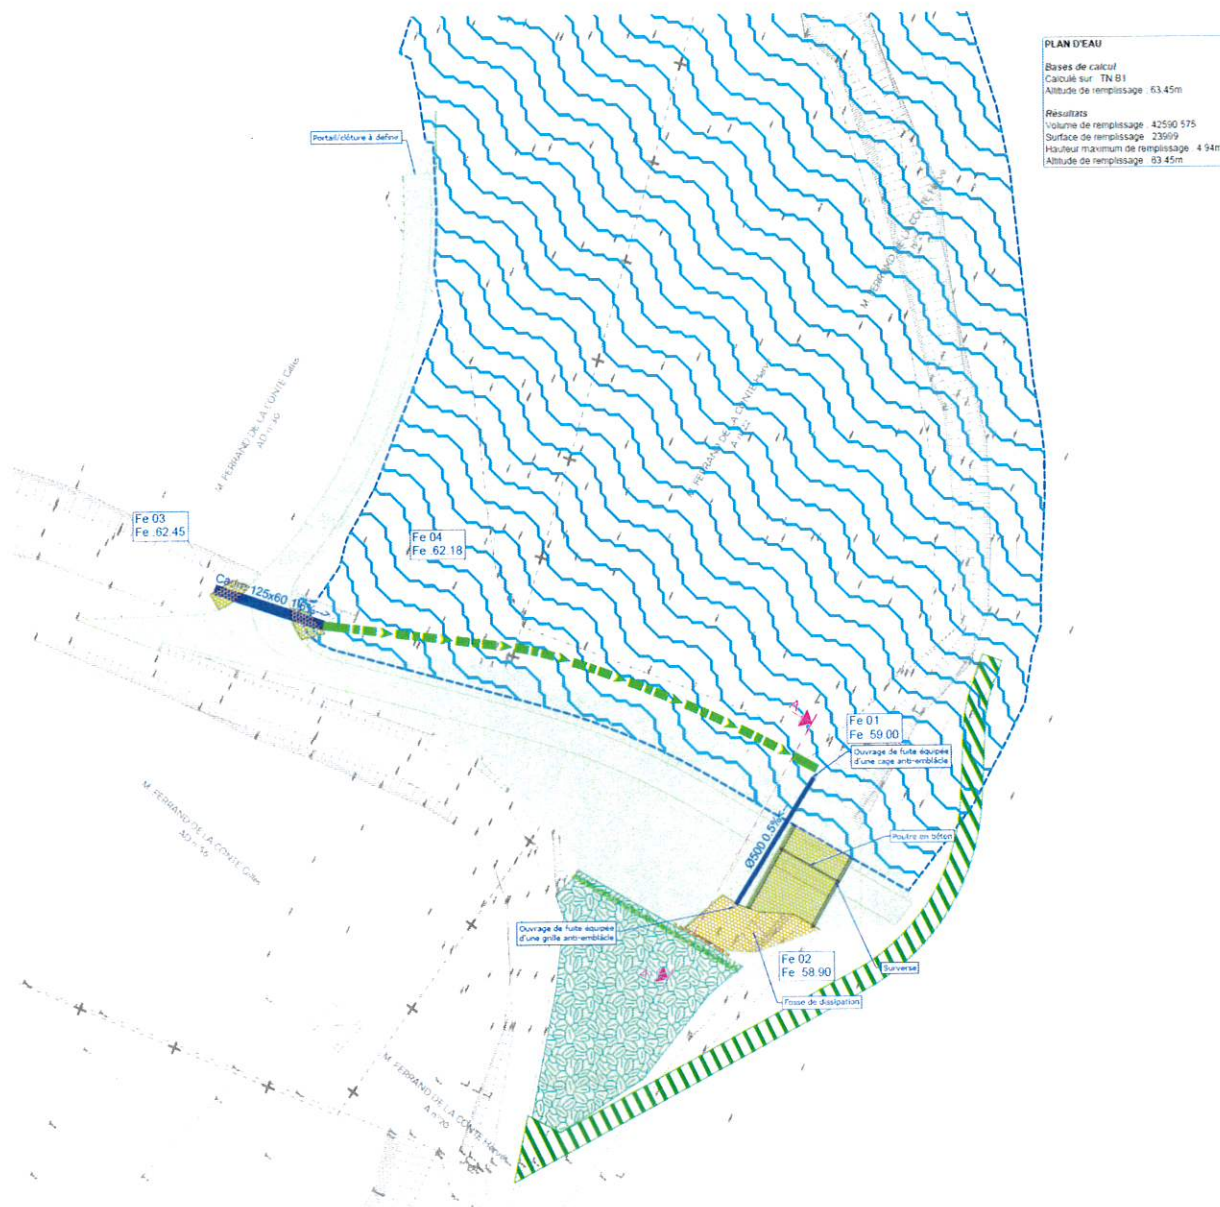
extrait du plan projet de l'ouvrage Essart 1 (source : Ingetec)
